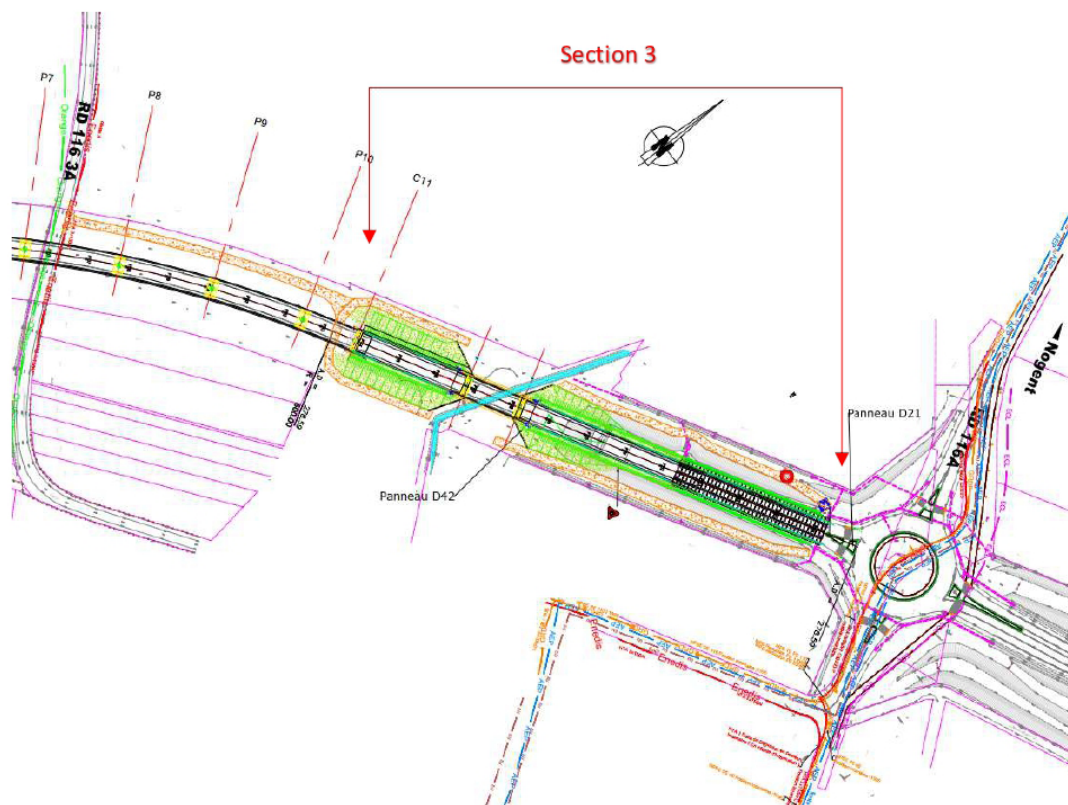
extrait du plan projet remis par le groupement d'entreprises dans son offre définitive
